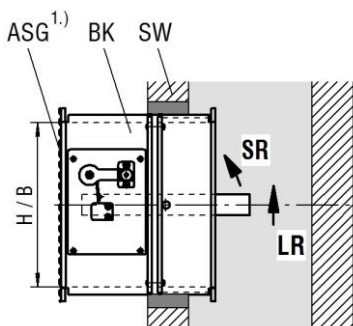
Esempio di collegamento di un canale di aerazione in pareti a pozzetto massicce
